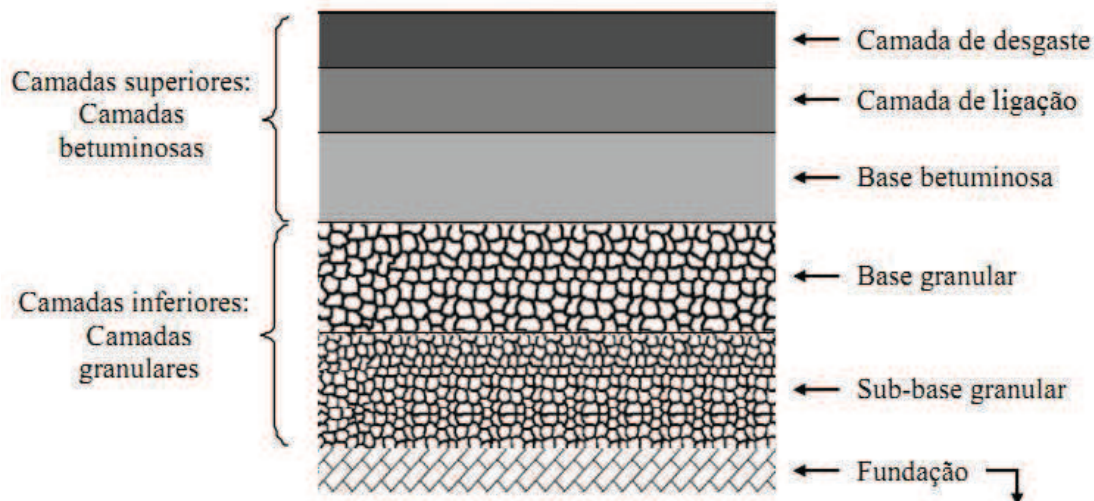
Constituição tipo de um pavimento rodoviário flexível atual [22]
